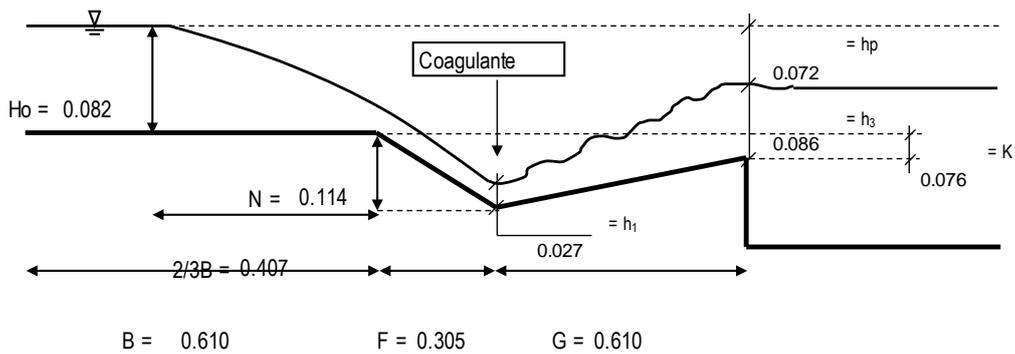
Esquema de Canaleta Parshall – Perfil (Elaboración: Propia)
